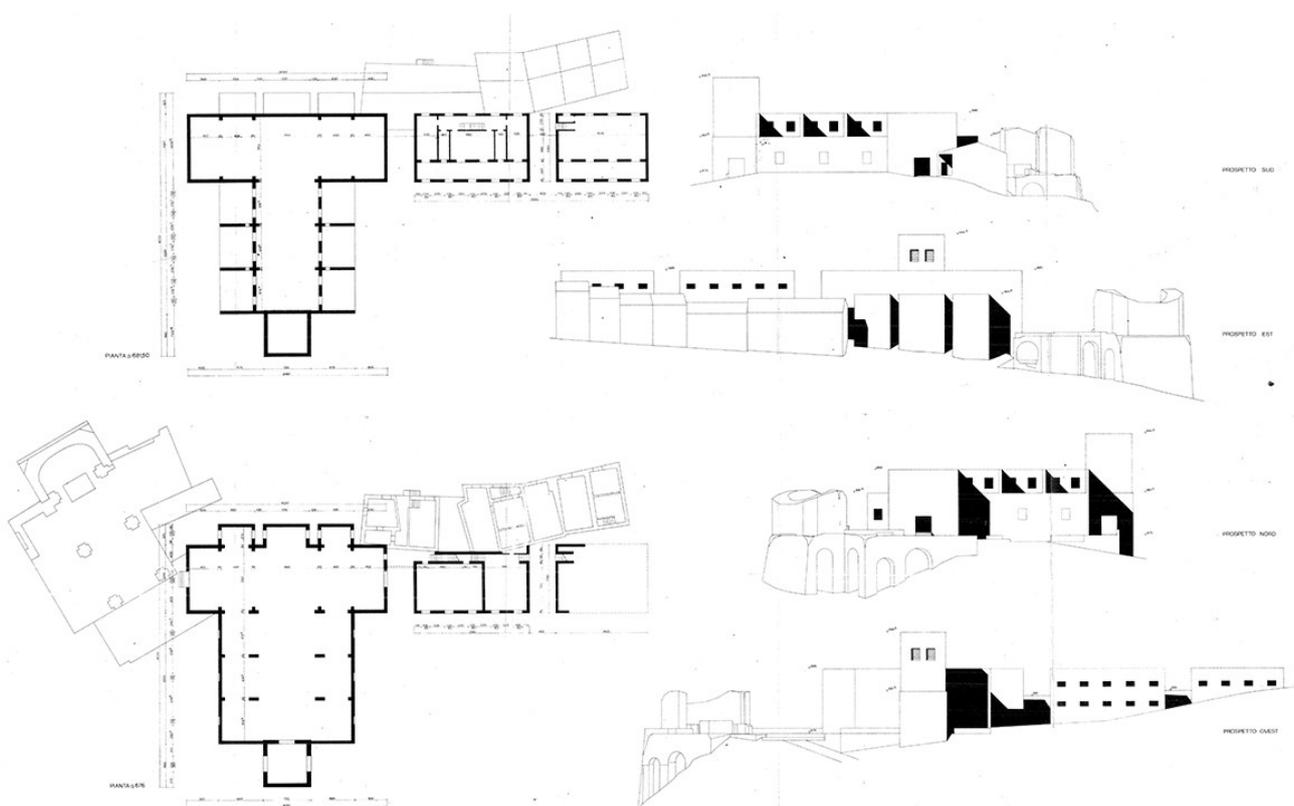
Piano di Recupero di Teora: progetto della Chiesa Madre (piante e prospetti)
